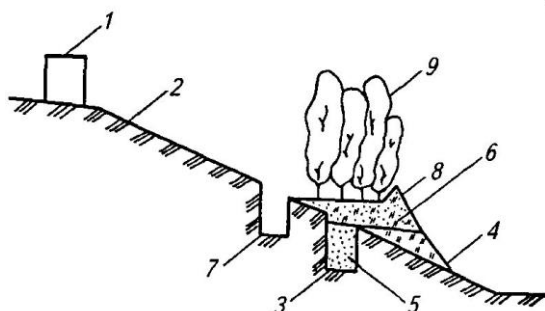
Спосіб попередження надходження на балкове дно гнойових стоків з території тваринницьких ферм і комплексів: 1 – ферма; 2 – балочний схил; 3 – перша траншея; 4 – підстава з ґрунту; 4 – тверда фаза гною; 6 – ґрунт, витягнутий з другої траншеї; 7 – друга траншея; 8 – земляний вал; 9 – лісова смуга
